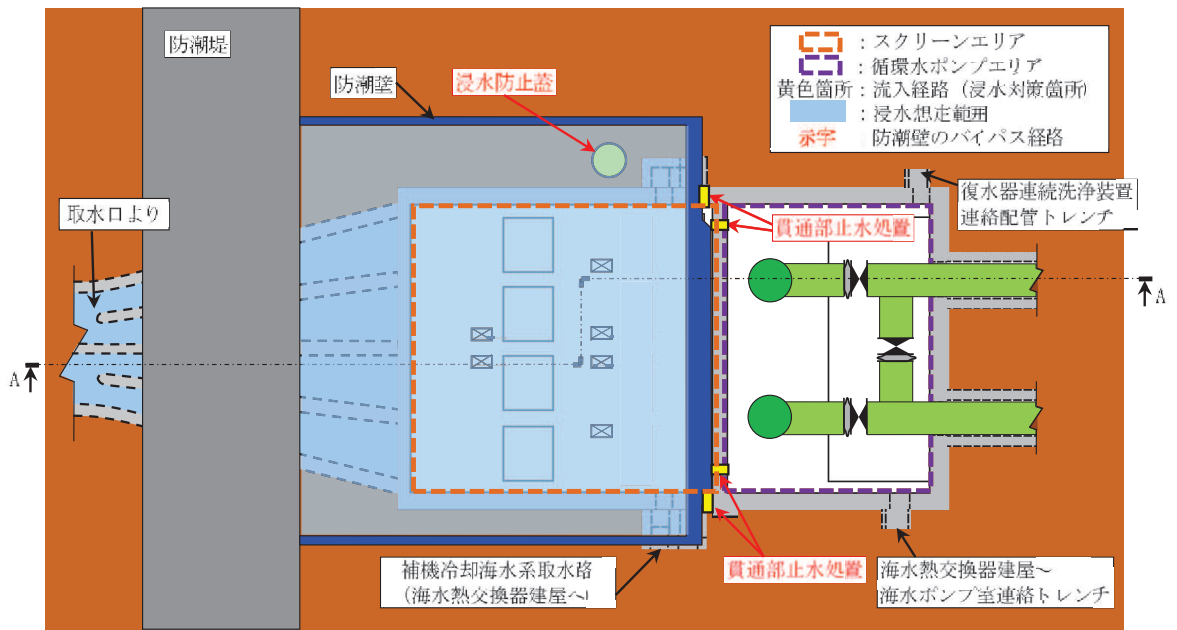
(1) 第 3 号機 海水ポンプ室 流入対策配置図 (平面図)
